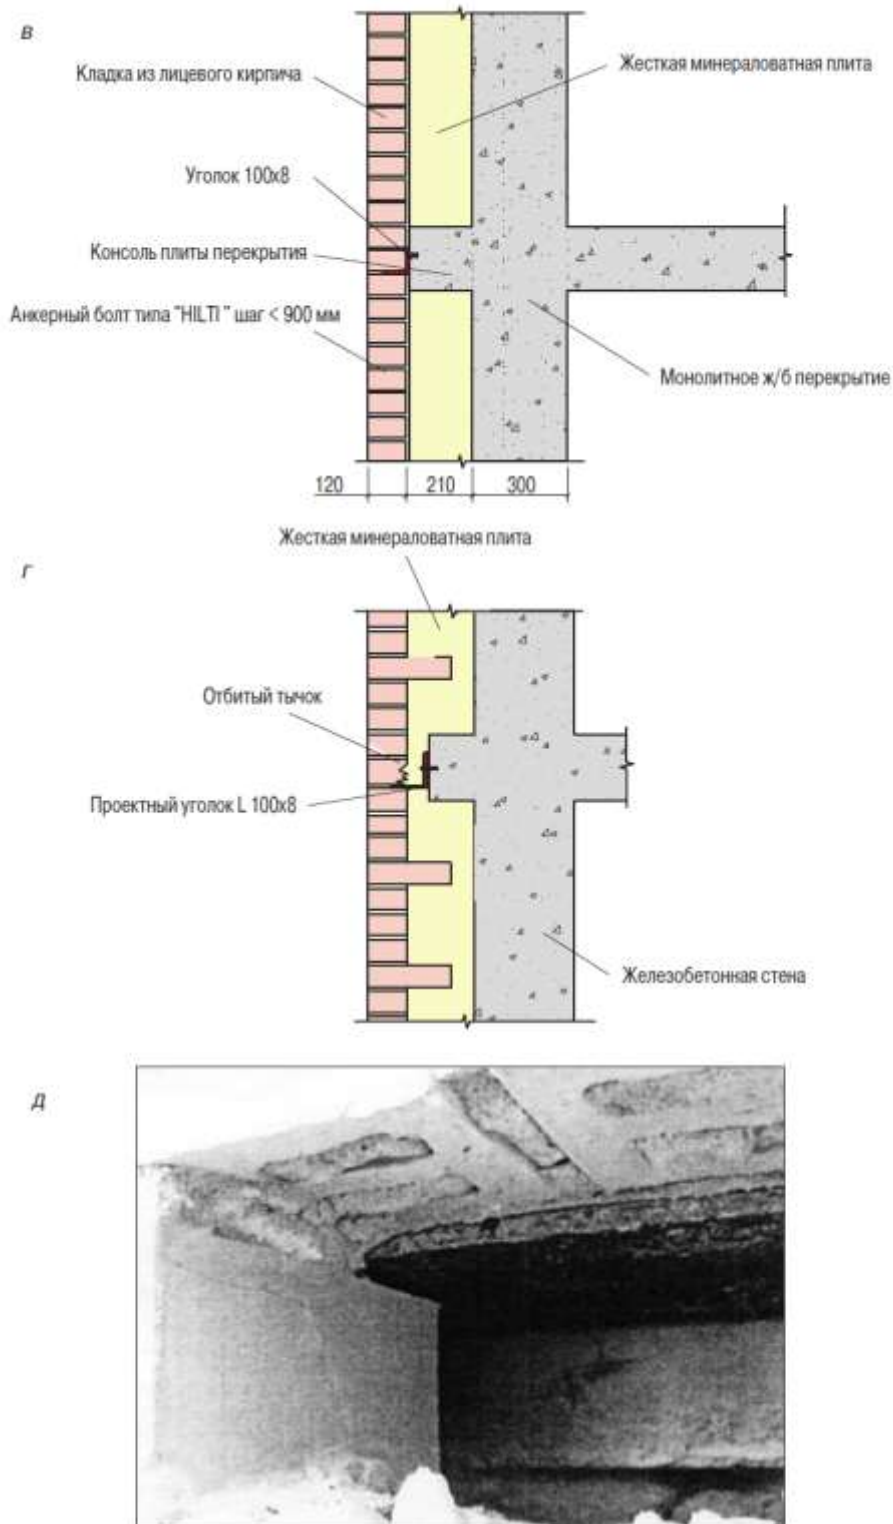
в, г, д. Жилой дом на ул. Магнитогорской в г. Москве: в- проектное решение узла крепления лицевого слоя кладки наружной стены к монолитной железобетонной стене; г- узлы опирания лицевого слоя по результатам обследования; д- свес кирпича со стального уголка
